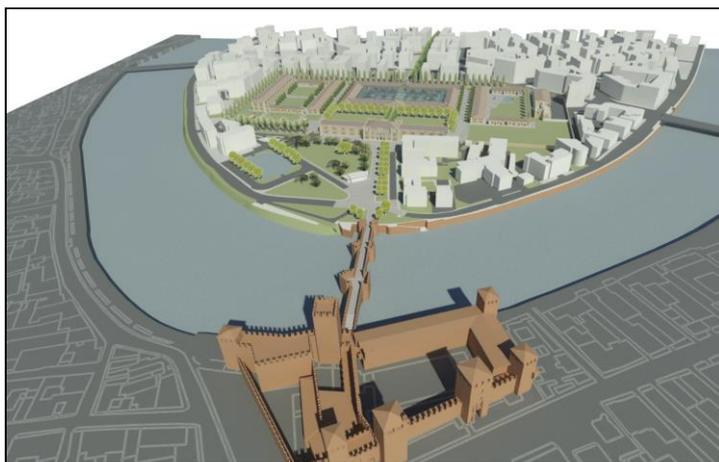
Render Vista da sud. Castelvecchio, Ponte Scaligero
